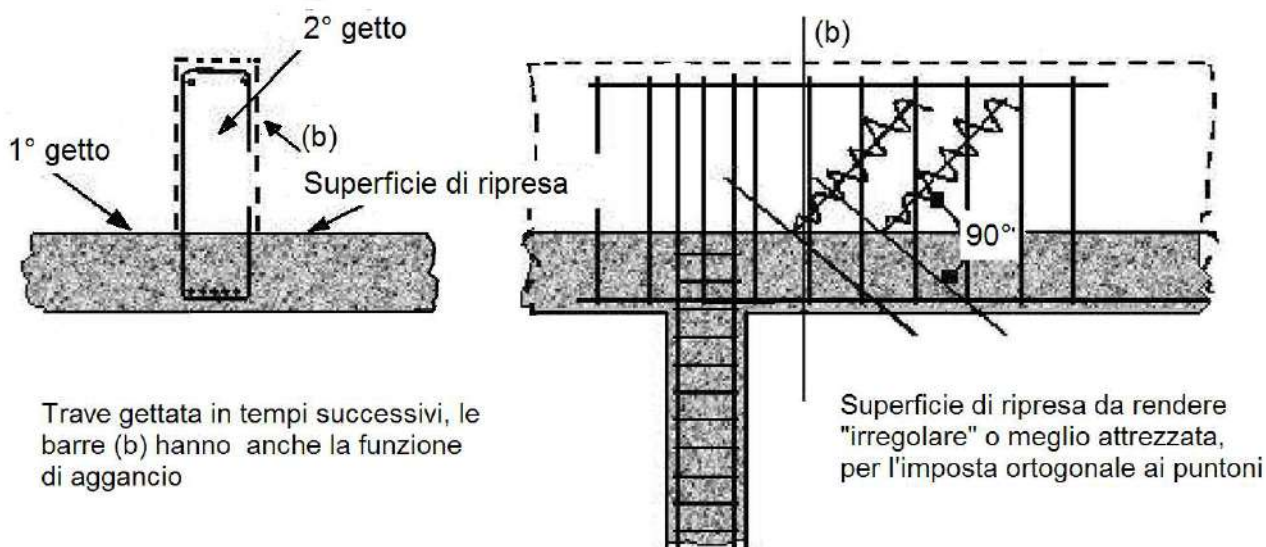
Modalità di ripresa del getto su travi di spessore elevato
